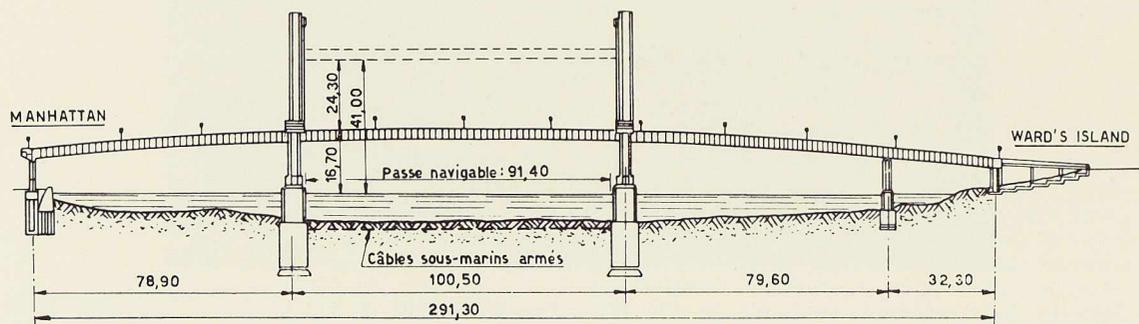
Elévation du pont levant sur le Harlem River à New-York. Cet ouvrage détient le record mondial de la portée des ponts de ce type.
